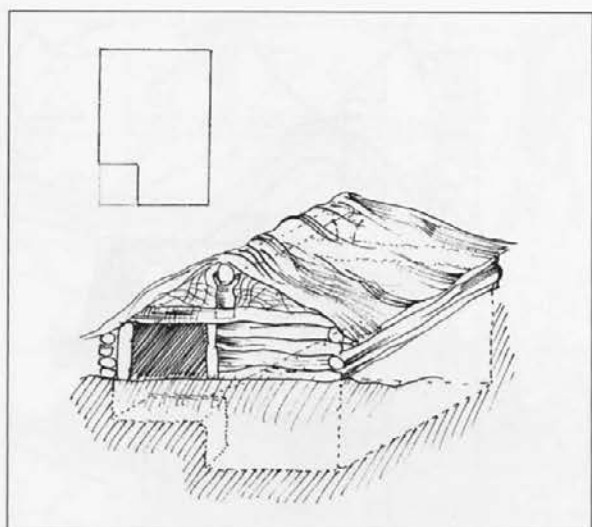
Ménfőcsanak-Szeles. Hausrekonstruktion Typ 3 mit Erdtreppe.
